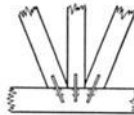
Druckstoß mit kleinen Zapfen und Bauklammern.
